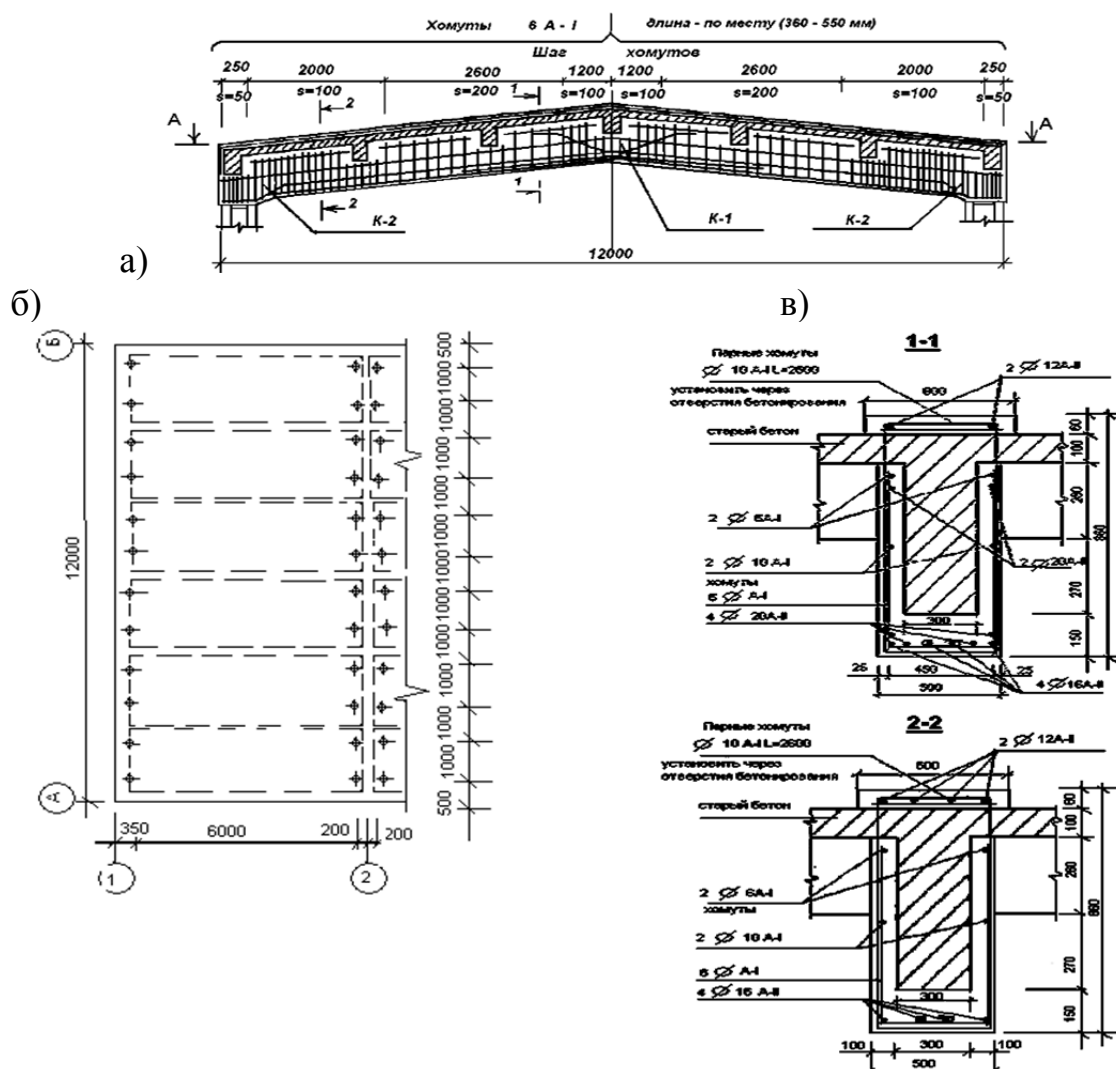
а - схема усиления ригеля поперечной рамы здания; б – схема расположения отверстий для бетонирования усиления ригеля; в – разрез по 1-1; г – разрез по 2-2
